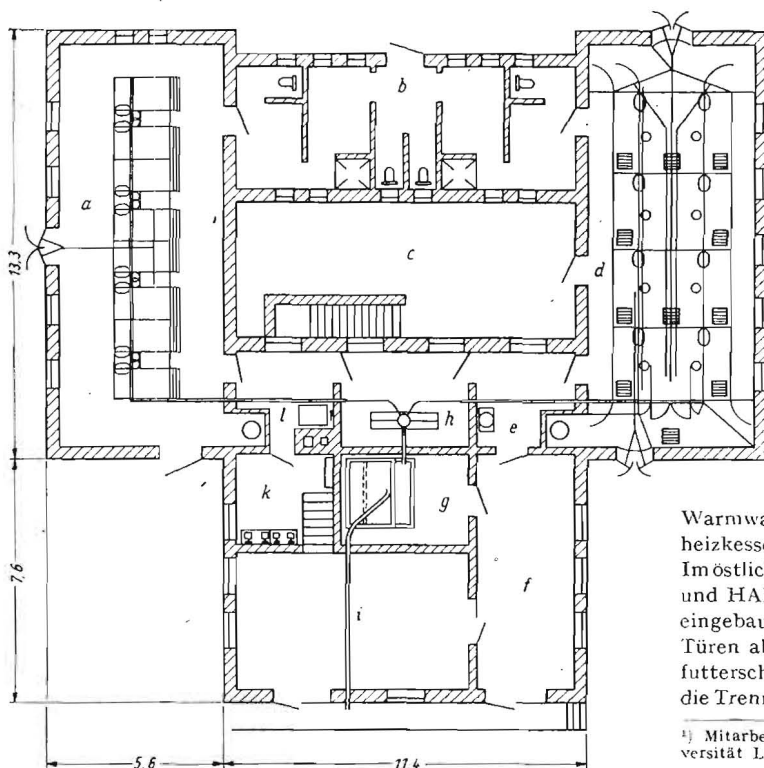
Grundriß Melkstand- und Speichergebäude (Maße in m).
